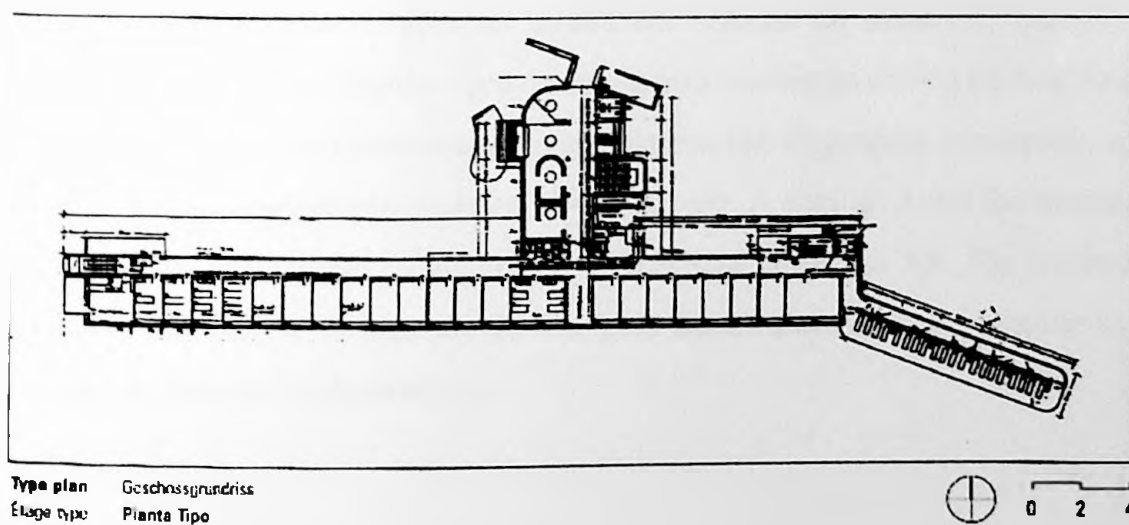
Alvar Aalto, Sanatório Paimio, 1929-1932 – planta tipo.
